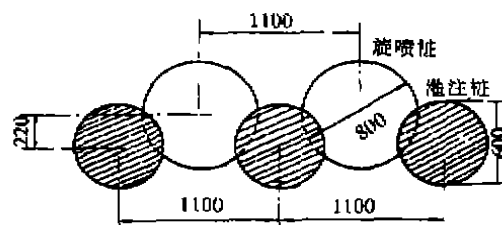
夫子庙商场施工支护结构平面尺寸组合图(单位:mm)
